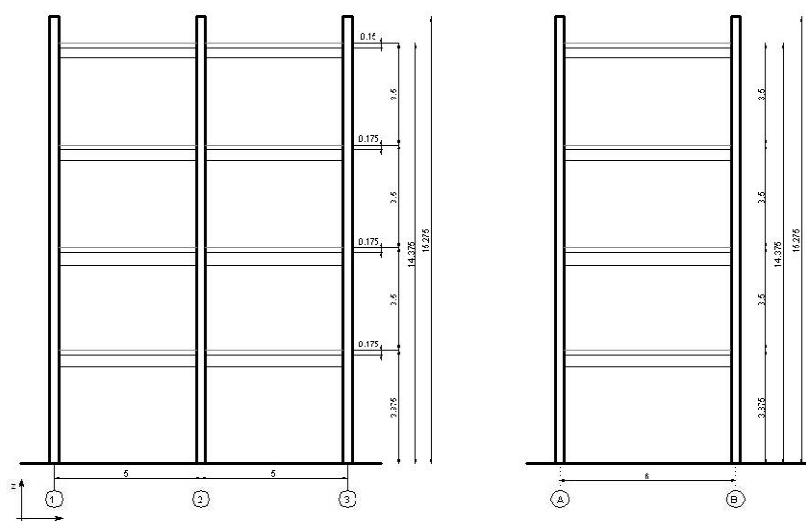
Vista em alçado da estrutura em estudo (m)
